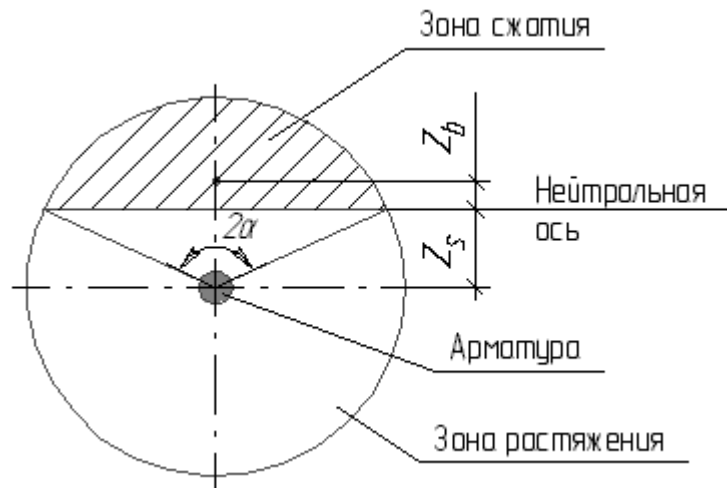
Расчетная схема для определения предельных усилий в сечении отдельно стоящих свай.
